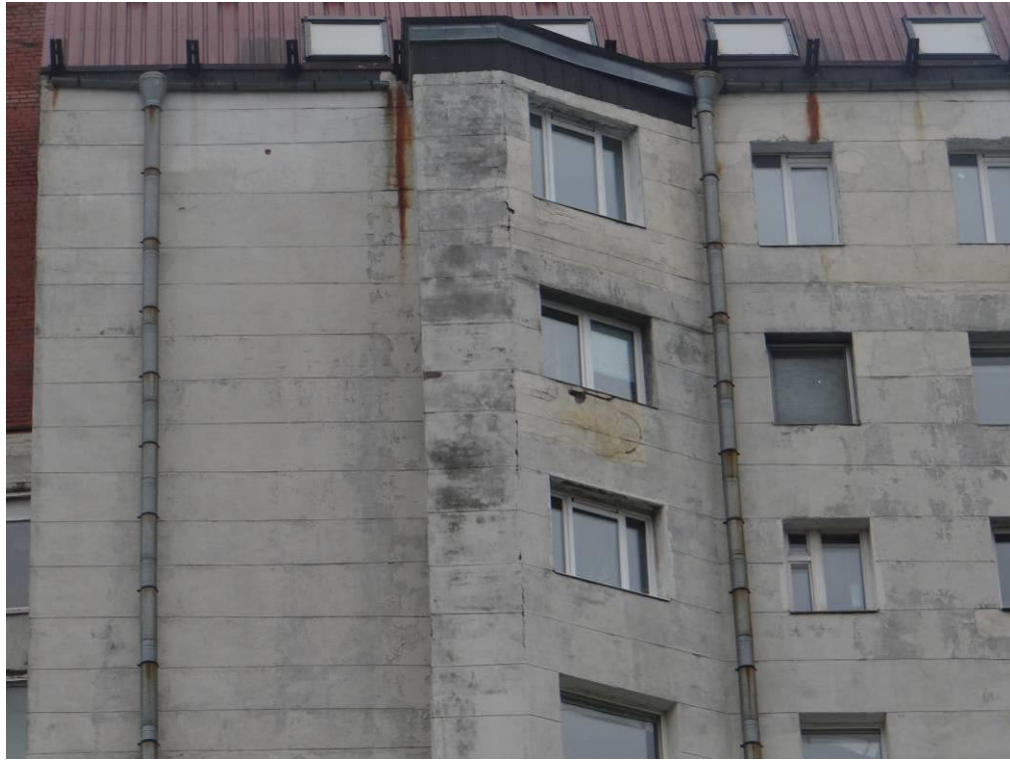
Фрагмент фасада по оси «Б» на участке в осях «12» - «13» в уровне 11-13 этажей. Следы увлажнения поверхностей фасада, приуроченные к кровельному свесу и элементам системы водостока. Сети разнонаправленных трещин в штукатурном покрытии. Участки обрушения штукатурного покрытия.
